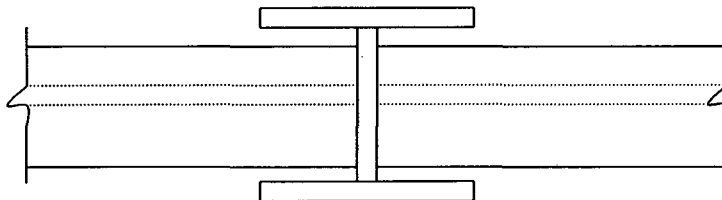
Ligação viga-pilar concentrada no eixo fraco.
